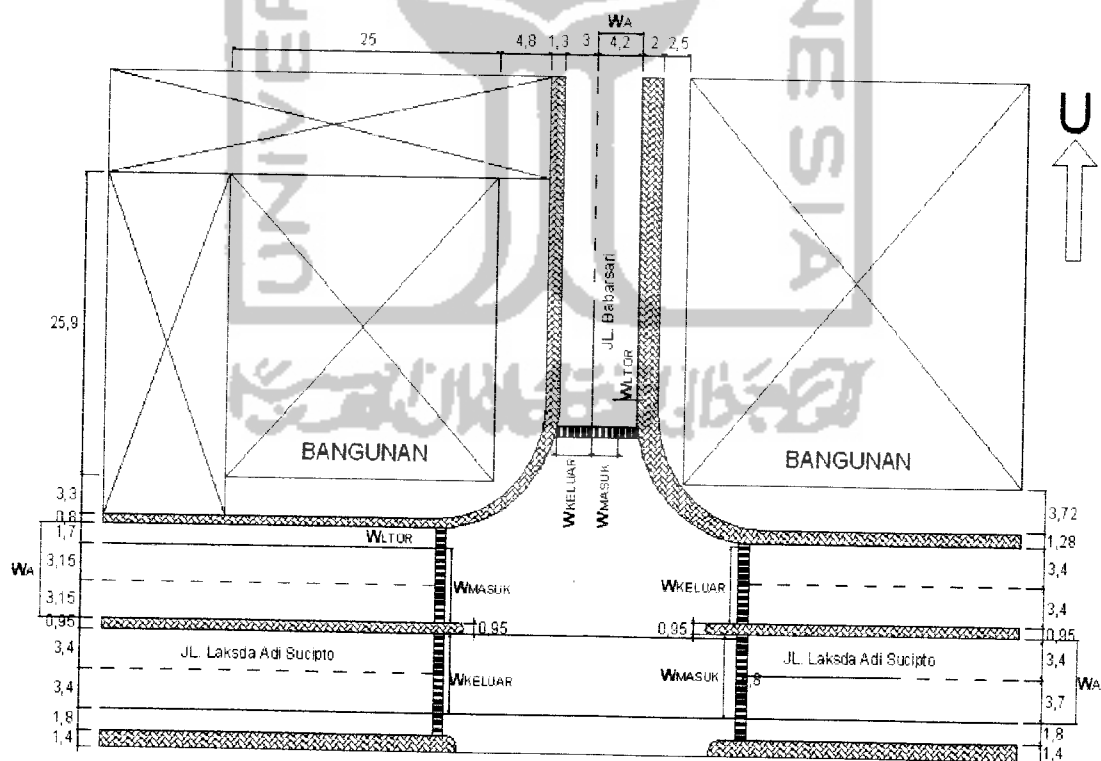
Kondisi geometrik pada simpang Janti
